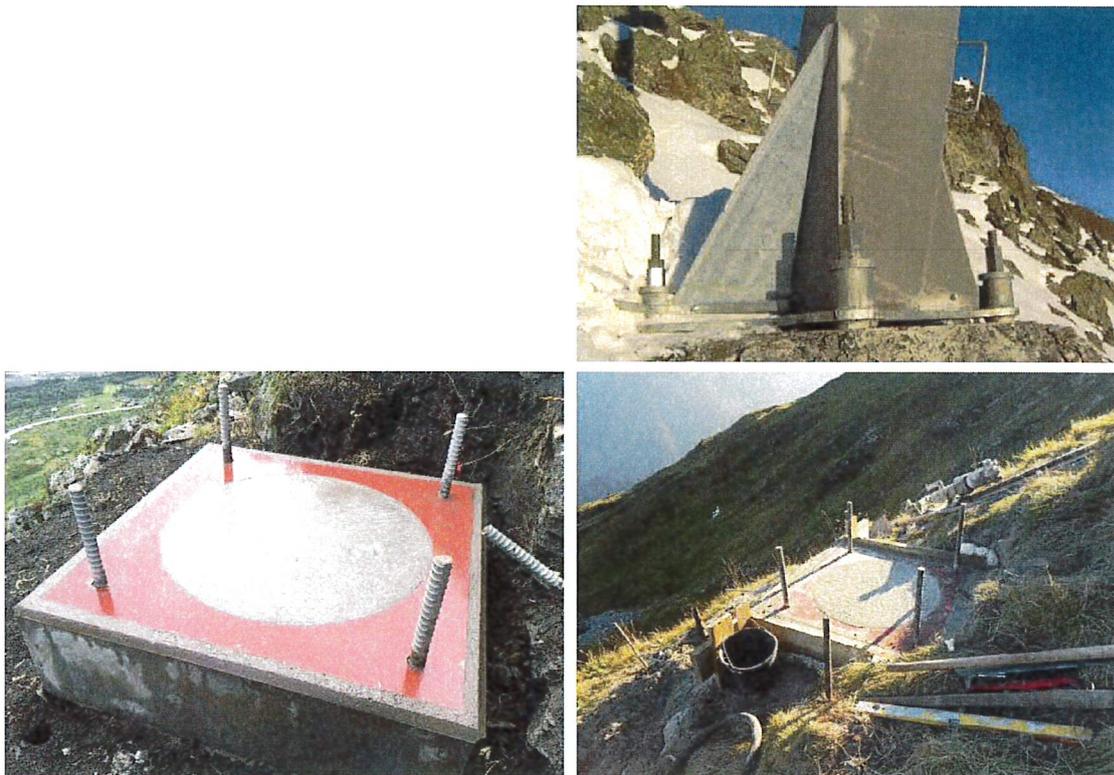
fondazione palo di detonazione LS 12-5 Wyssen
